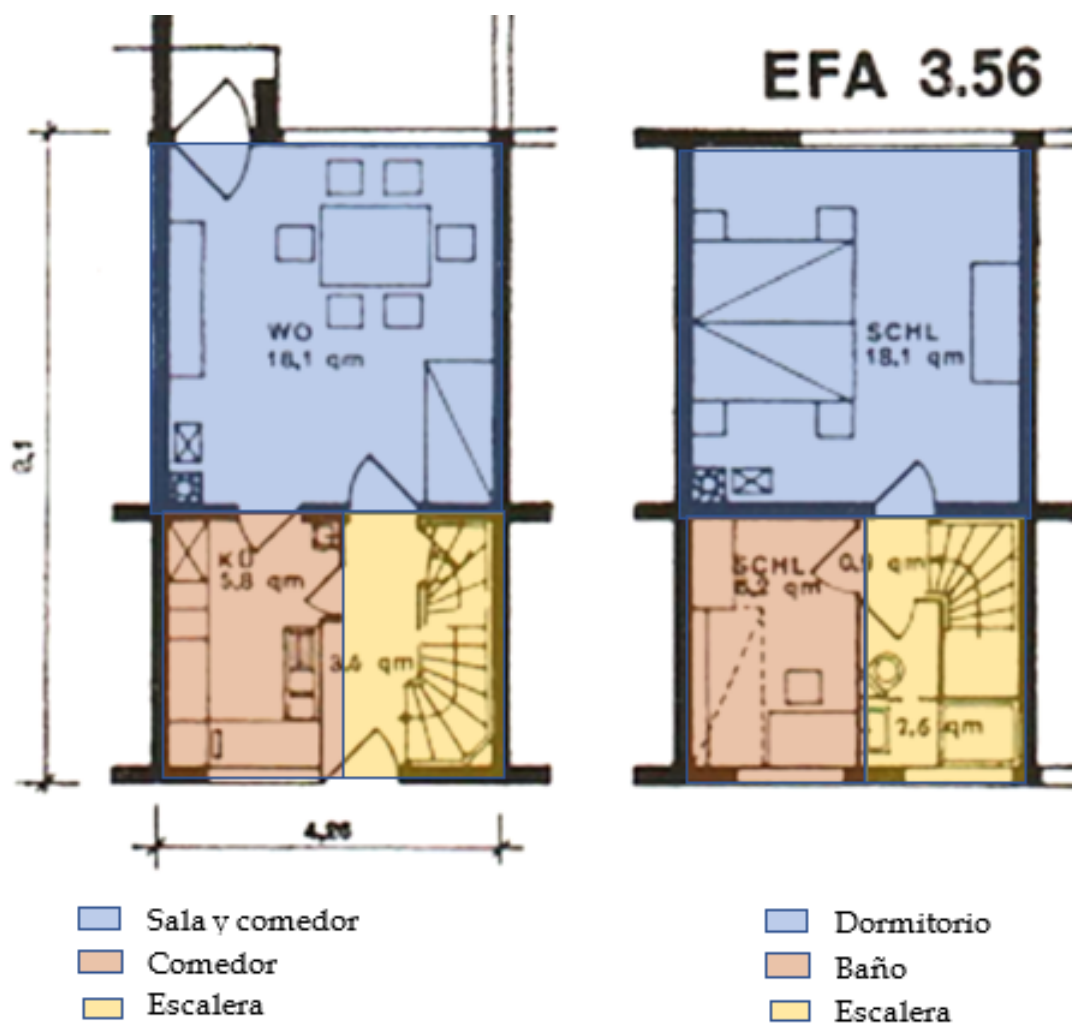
Planos de Frankfurt EFA 3.56.
